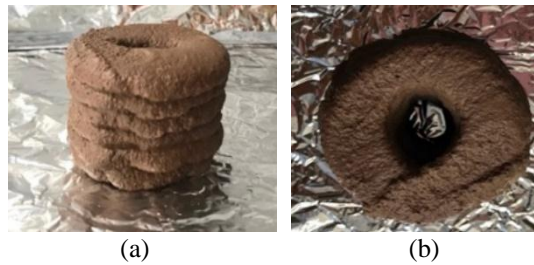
Proses *Printing* (sumber: hasil uji coba)
